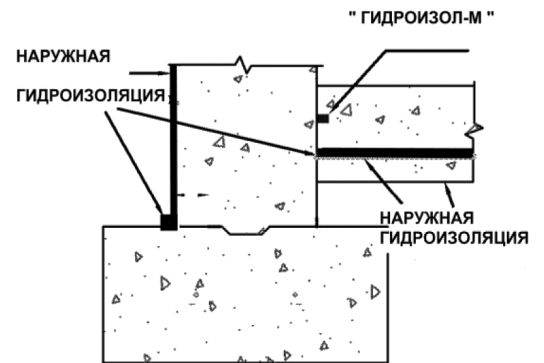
Монтаж шнура на сопряжении свайного оголовка и фундаментной плиты.
